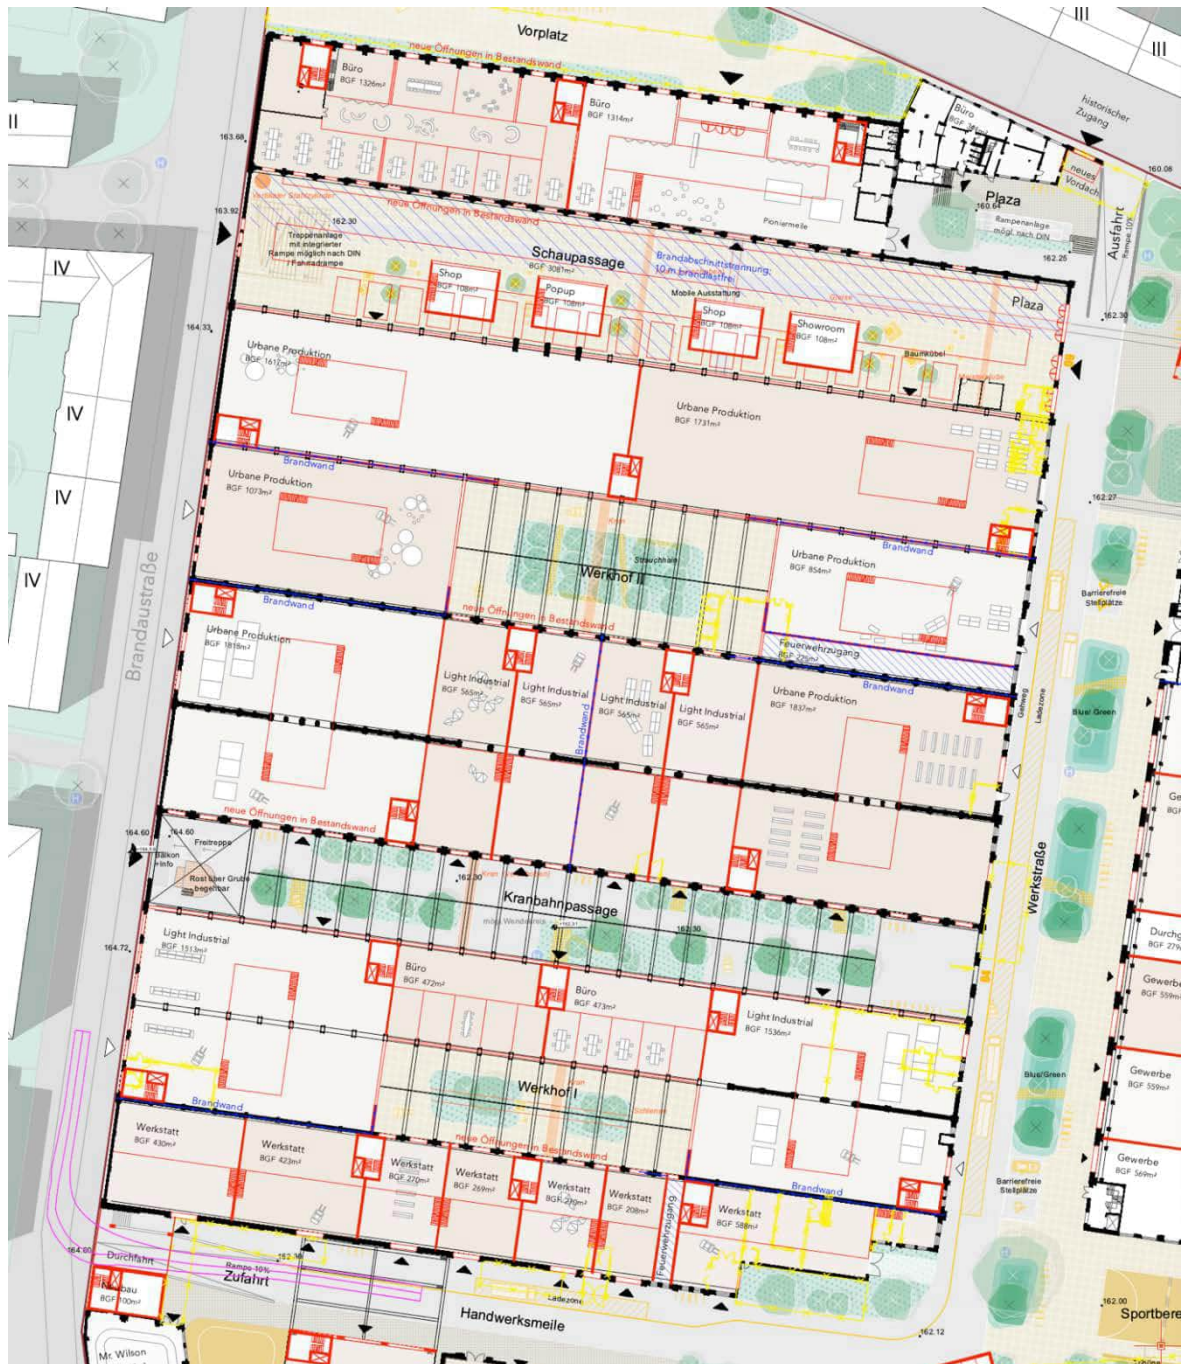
Grundriss Erdgeschoss R5, Abbruch Raum- in- Raum Einbauten, coido architects
